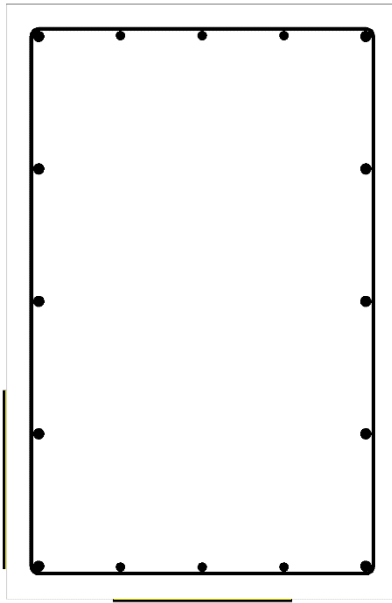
Disposição das chapas na secção do paralelo 8 - secção reforçada
